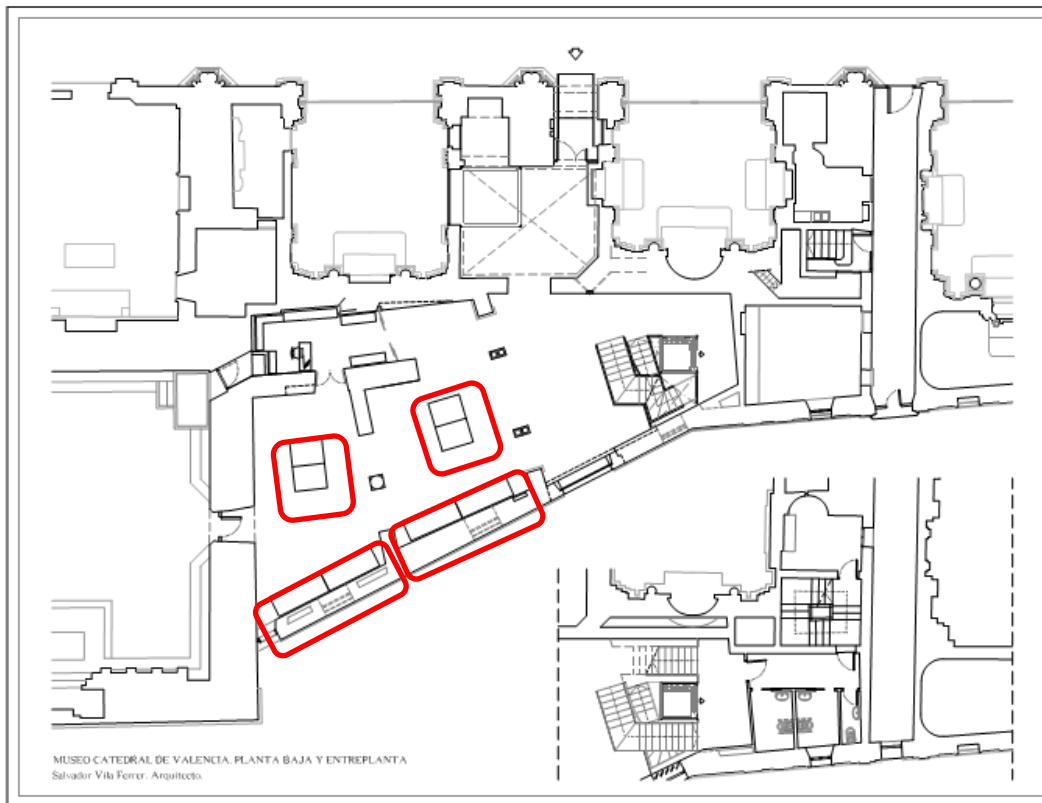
Plano de la planta baja y entreplanta del MCV. En rojo, vitrinas de exposición
